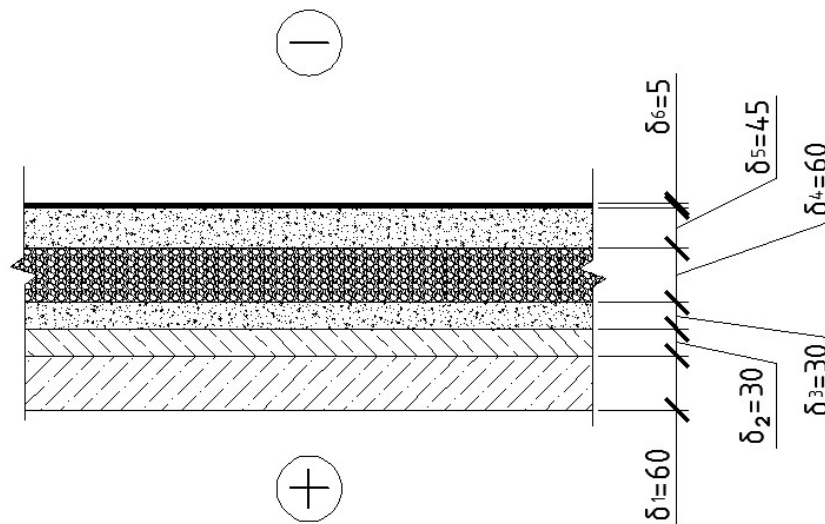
Розрахункова схема суміщеного перекриття
